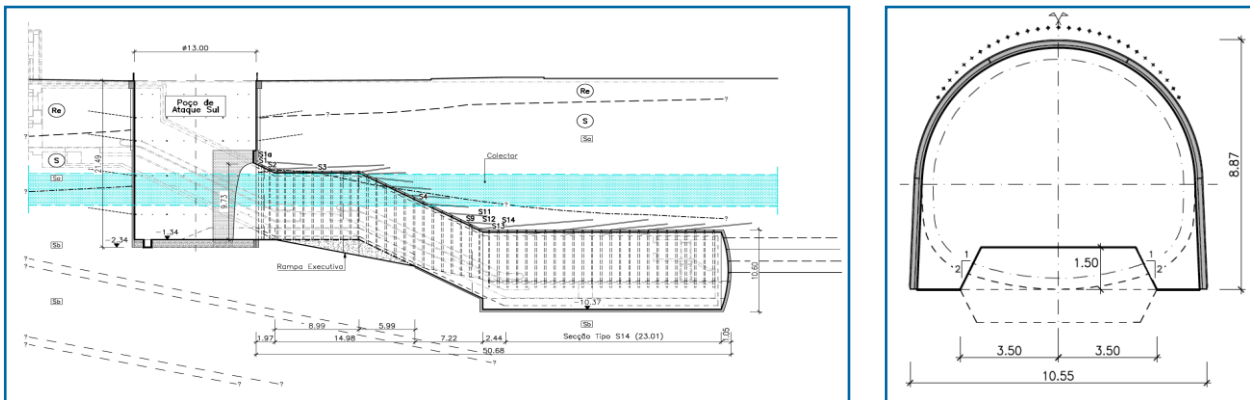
Corte longitudinal da solução de escavação ao longo do alinhamento do acesso Sul e secção tipo do túnel descendente
